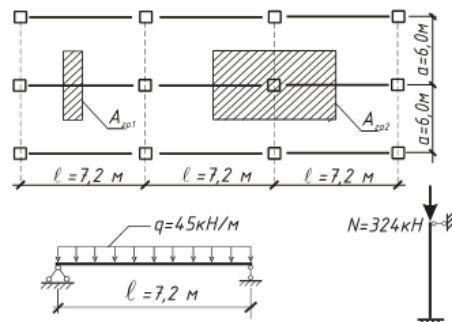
Грузовая площадь и расчетная схема балки и колонны
